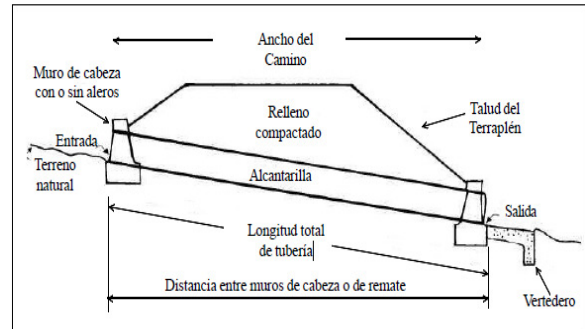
Detalle de alcantarilla (Fuente: Ingeniería de Caminos Rurales. AID)
